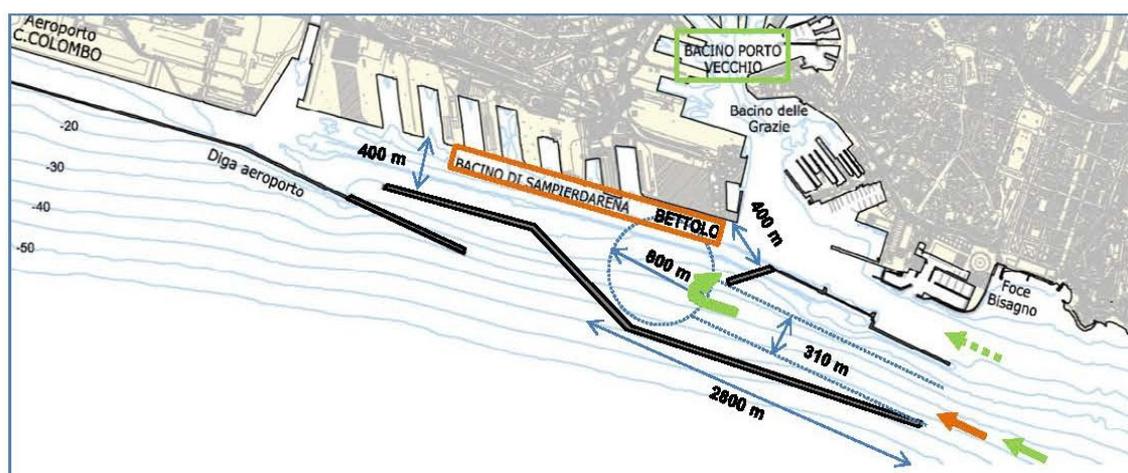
PLANIMETRIA DELLA NUOVA DIGA FORANEA NELLA SUA CONFIGURAZIONE FINALE
